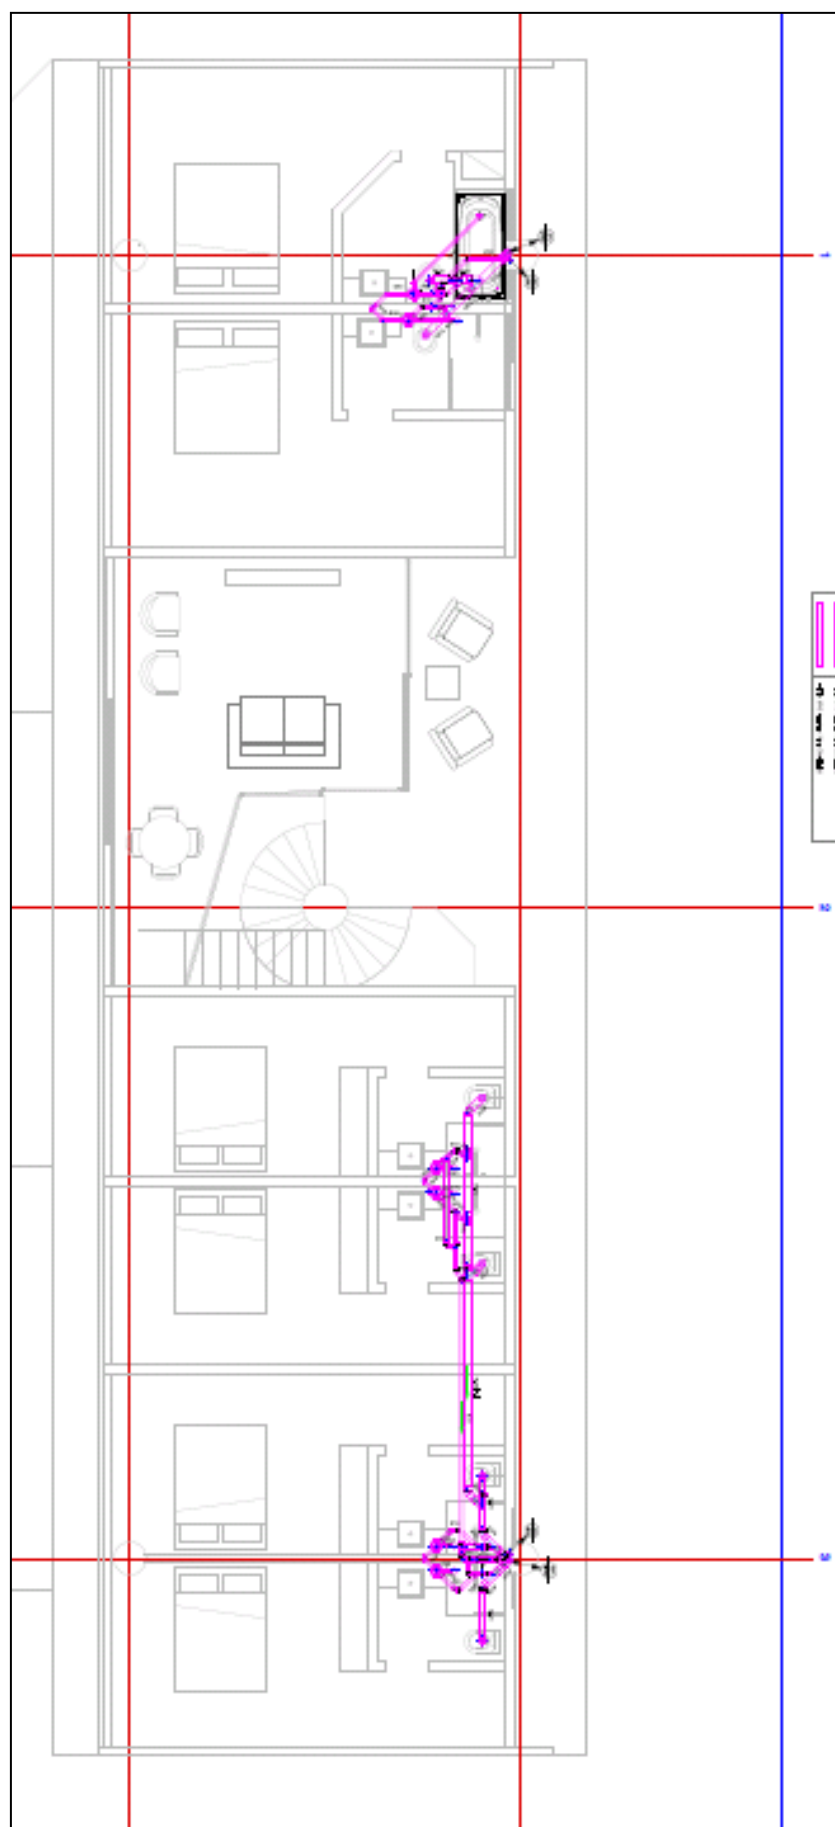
Rede de esgoto 1º pavimento. Fonte: AUTOR (2017).
